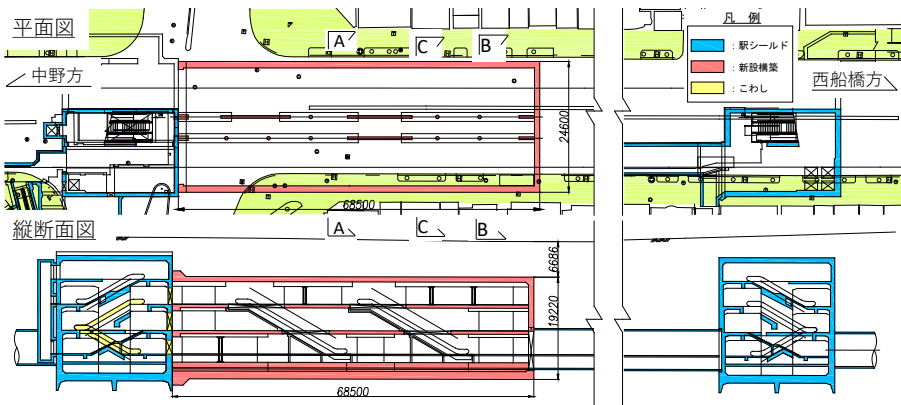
木場駅改良計画平面図（地上及び地下1階）及び縦断面図断
